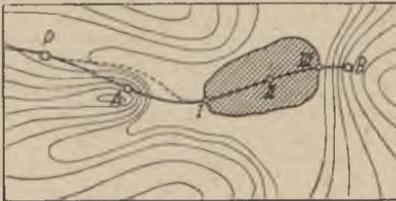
Auswahl der Lage des Hochbehälters — Lageplan
